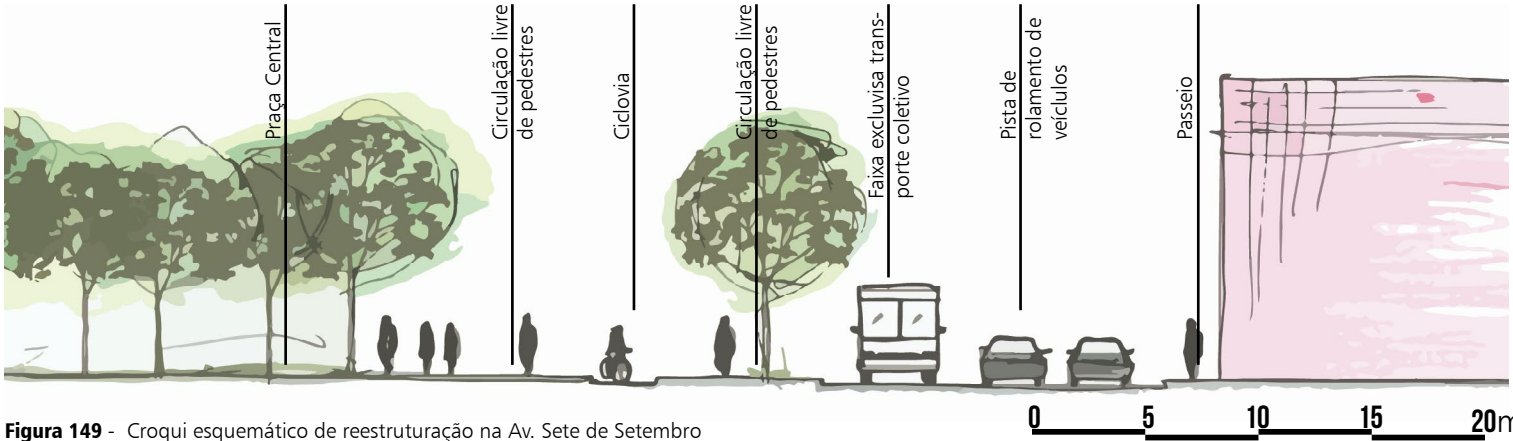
Croqui esquemático de reestruturação na Av. Sete de Setembro
